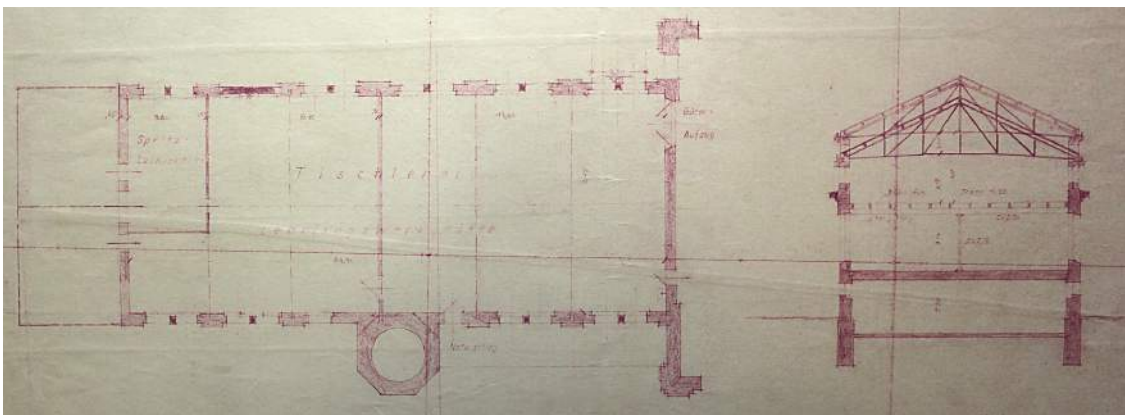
Anhebung der Dachkonstruktion auf dem Bau aus dem Jahr 1911
